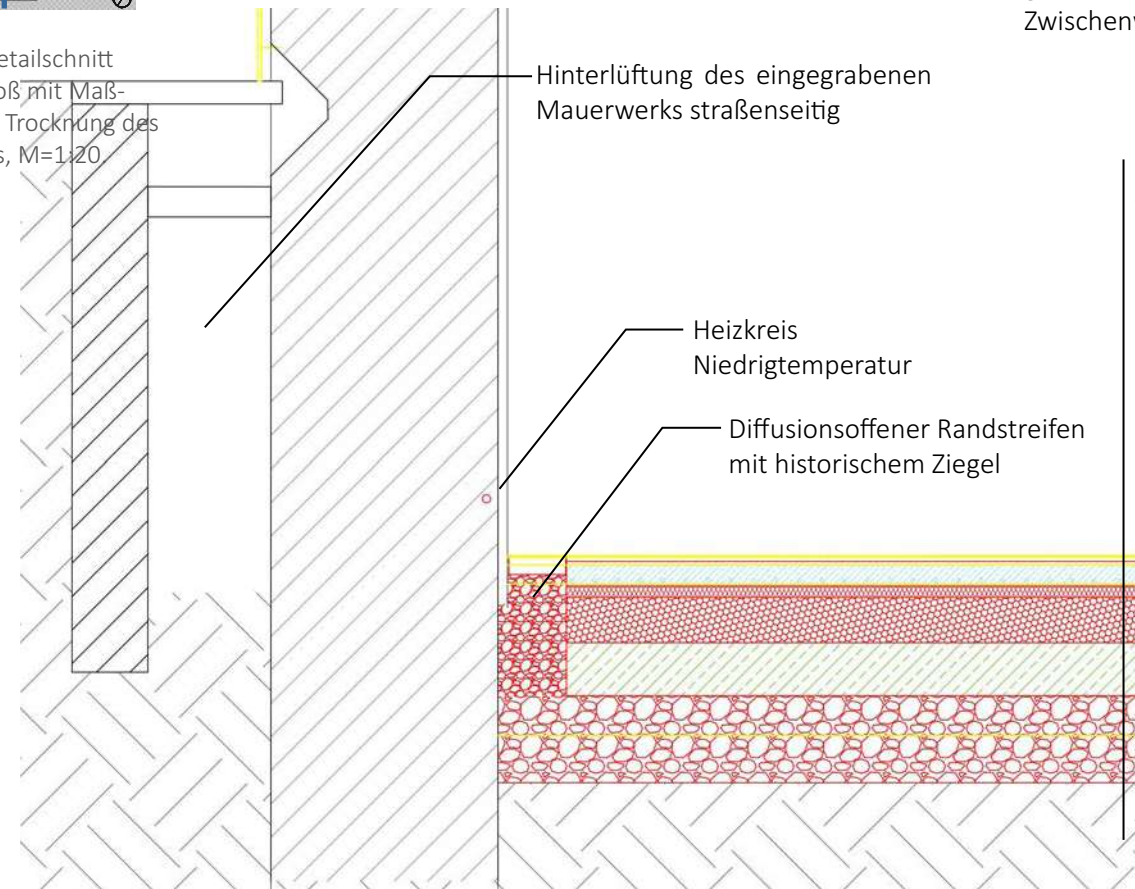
Detailschnitt Untergeschoß mit Maßnahmen zur Trocknung des Mauerwerks, M=1:20
